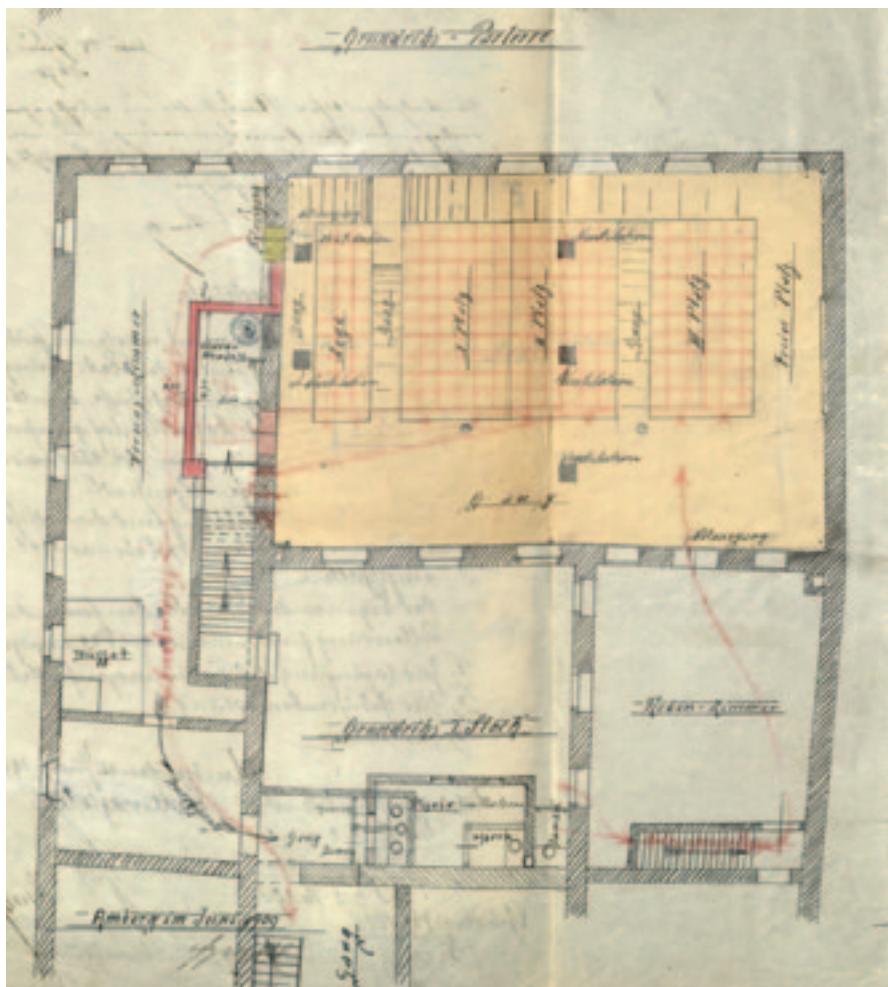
Lageplan des Tonbild-Theaters, 1909, Stadt Amberg, Bauaktenarchiv, BARg Bd. -242- 2.
